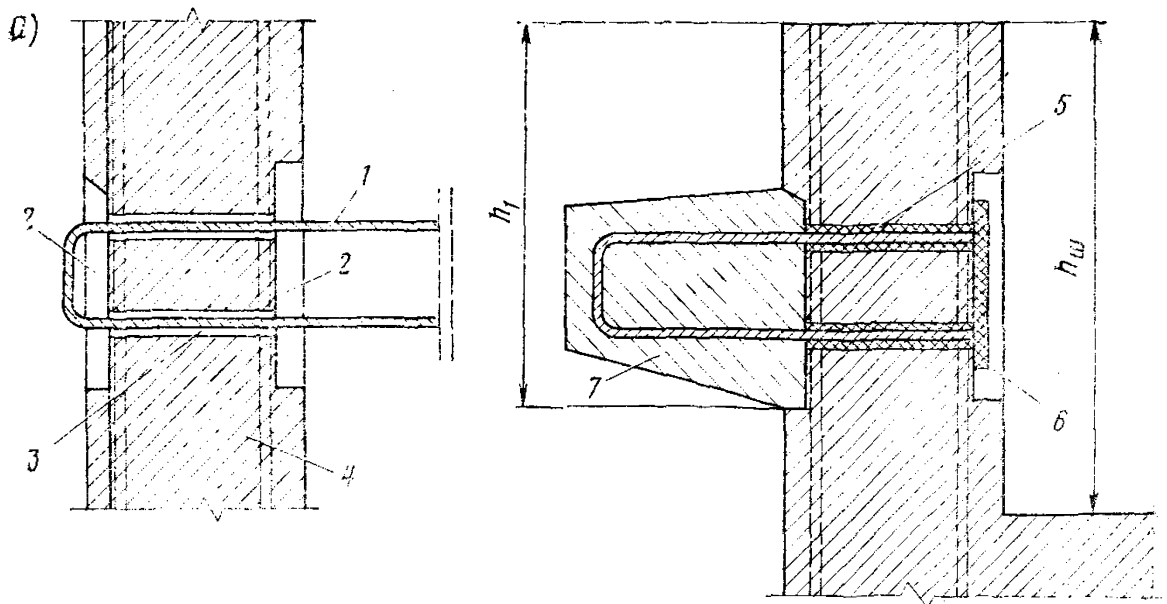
Схема пристройки к шкафной стенке консоли для опирания переходных плит:
